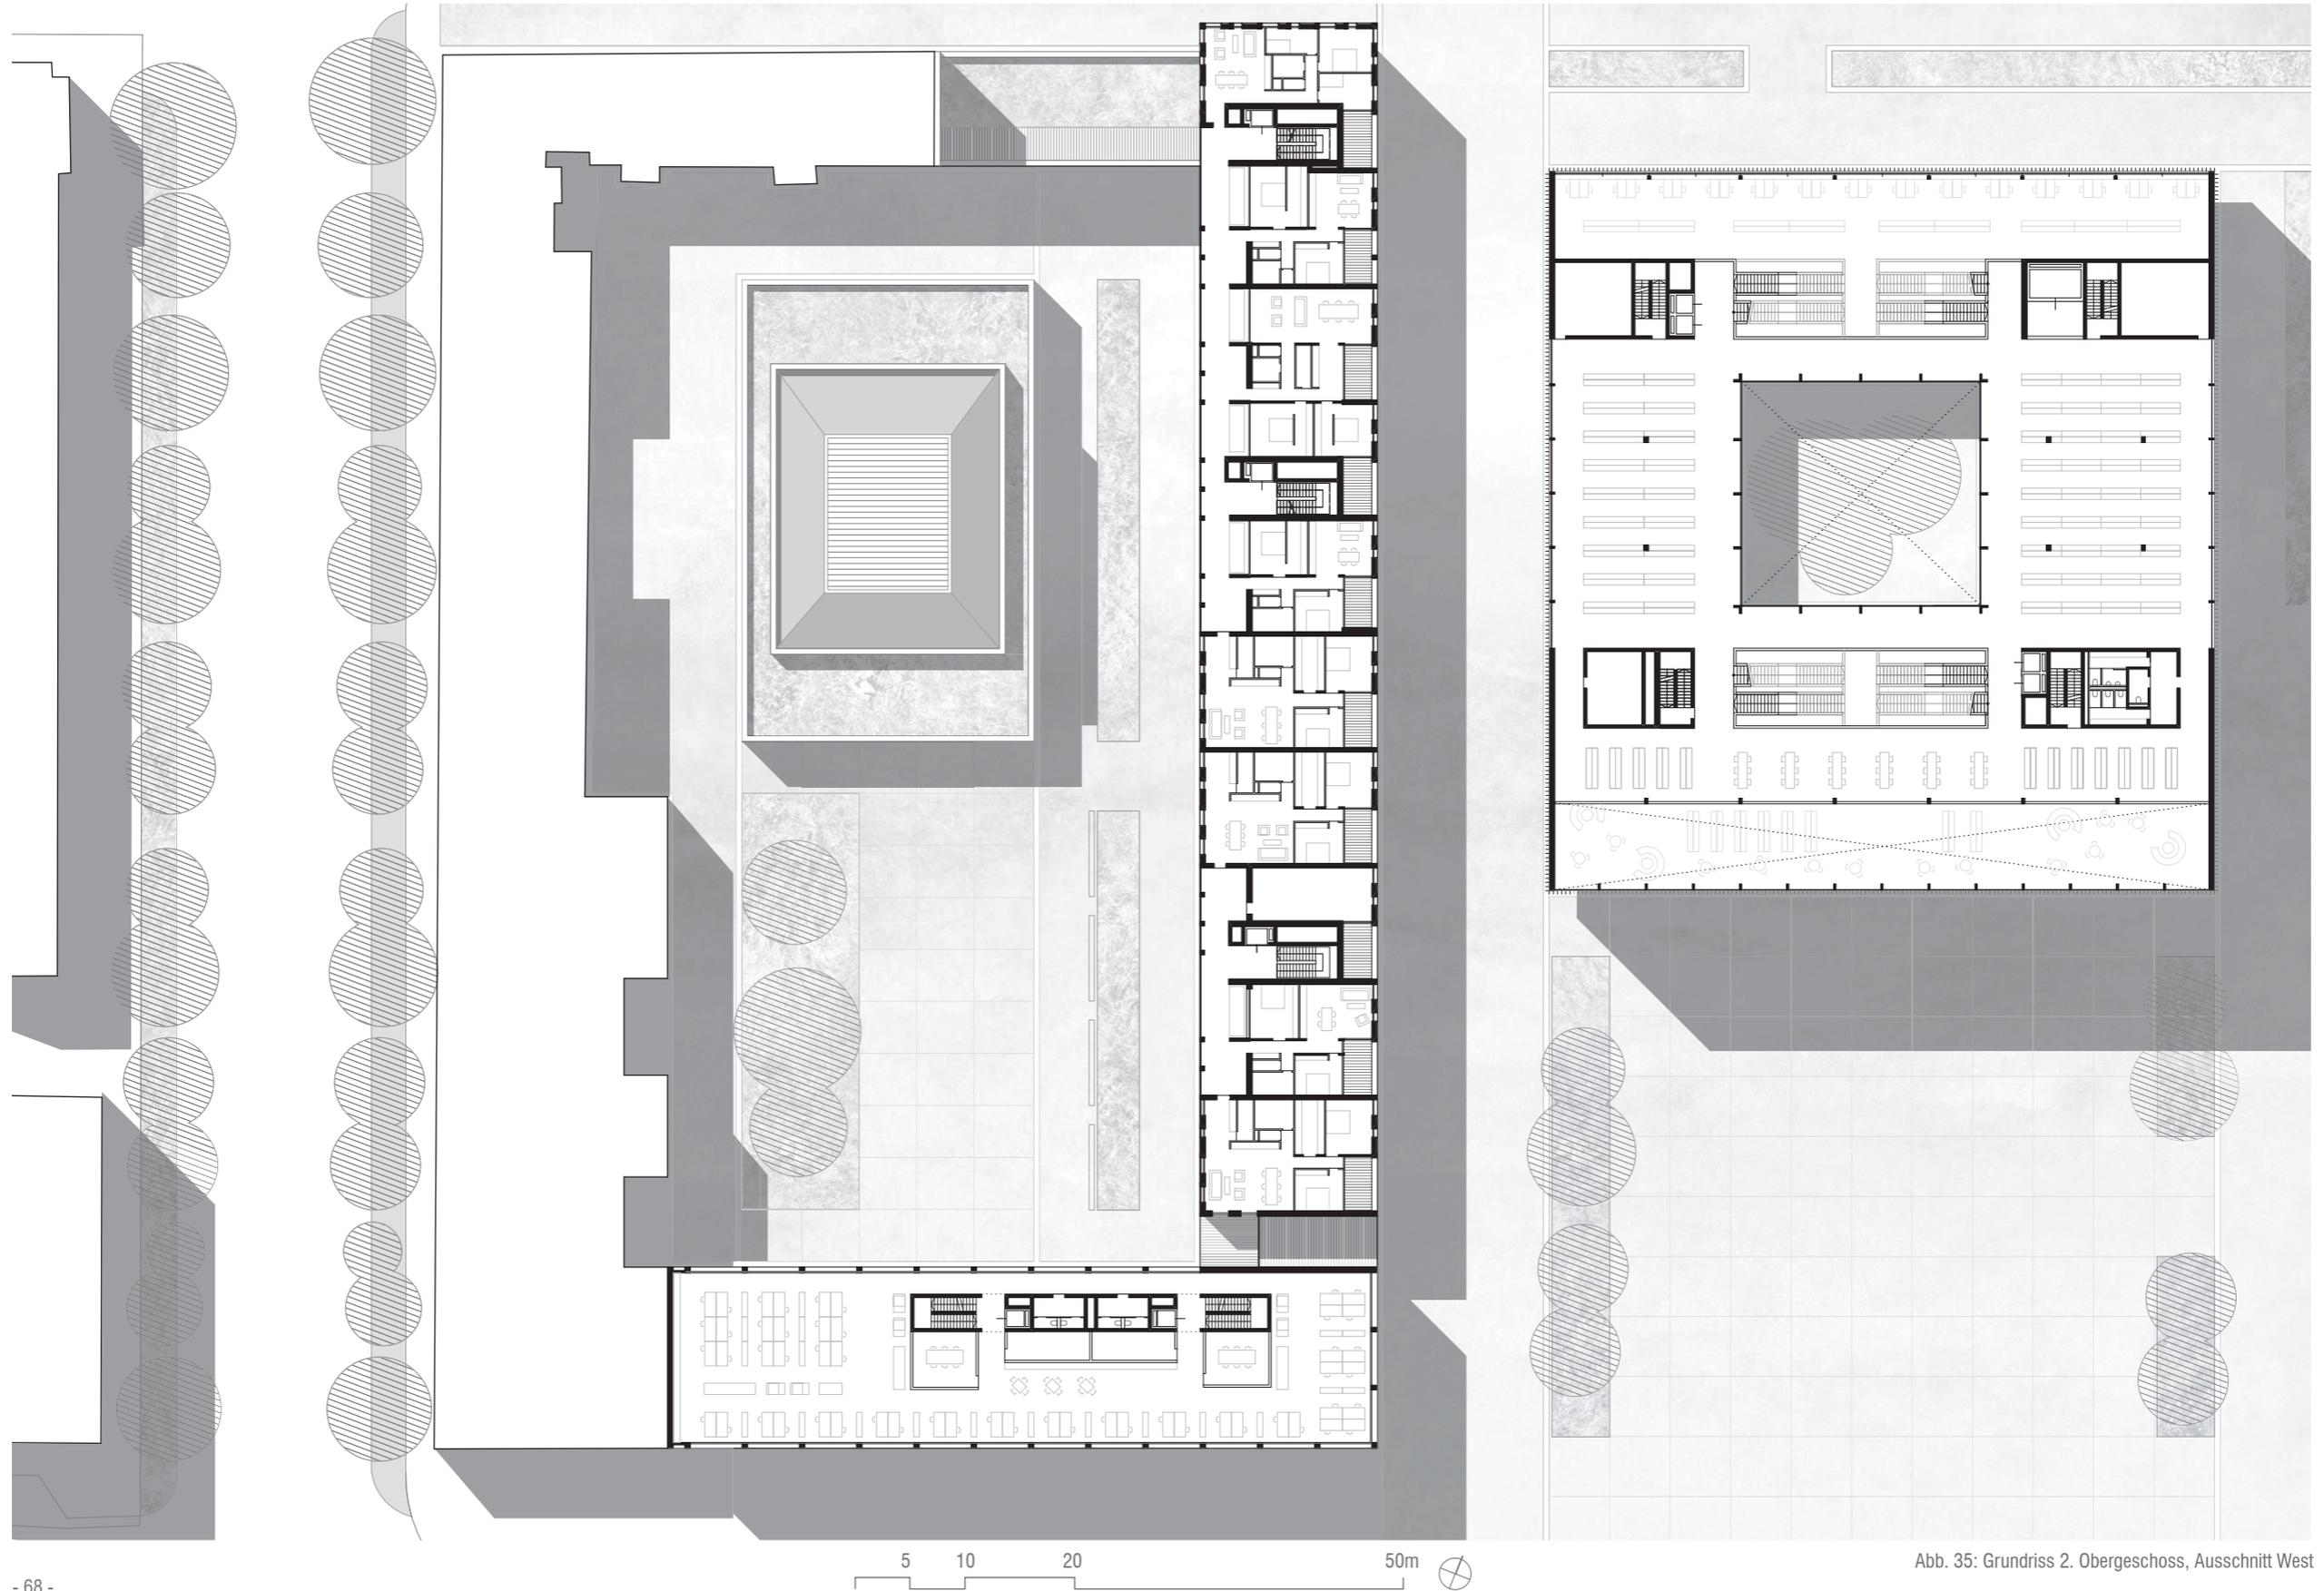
Grundriss 2. Obergeschoss, Ausschnitt West
